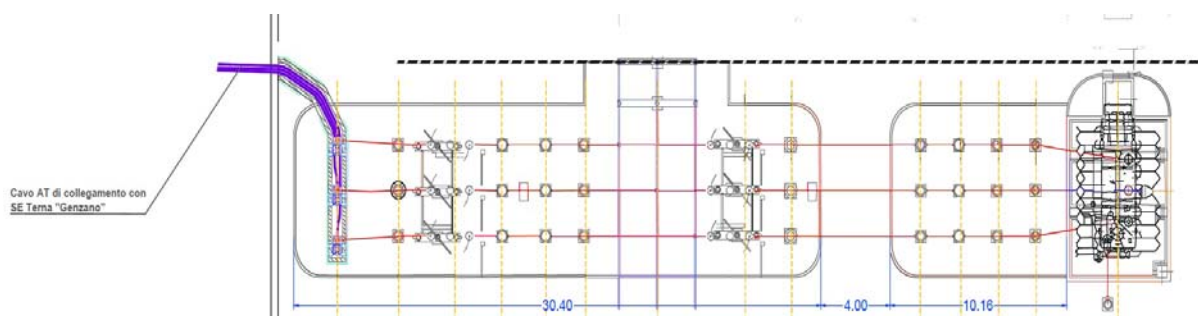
Dettaglio della connessione tra Stazione Utente e Stazione della RTN.
